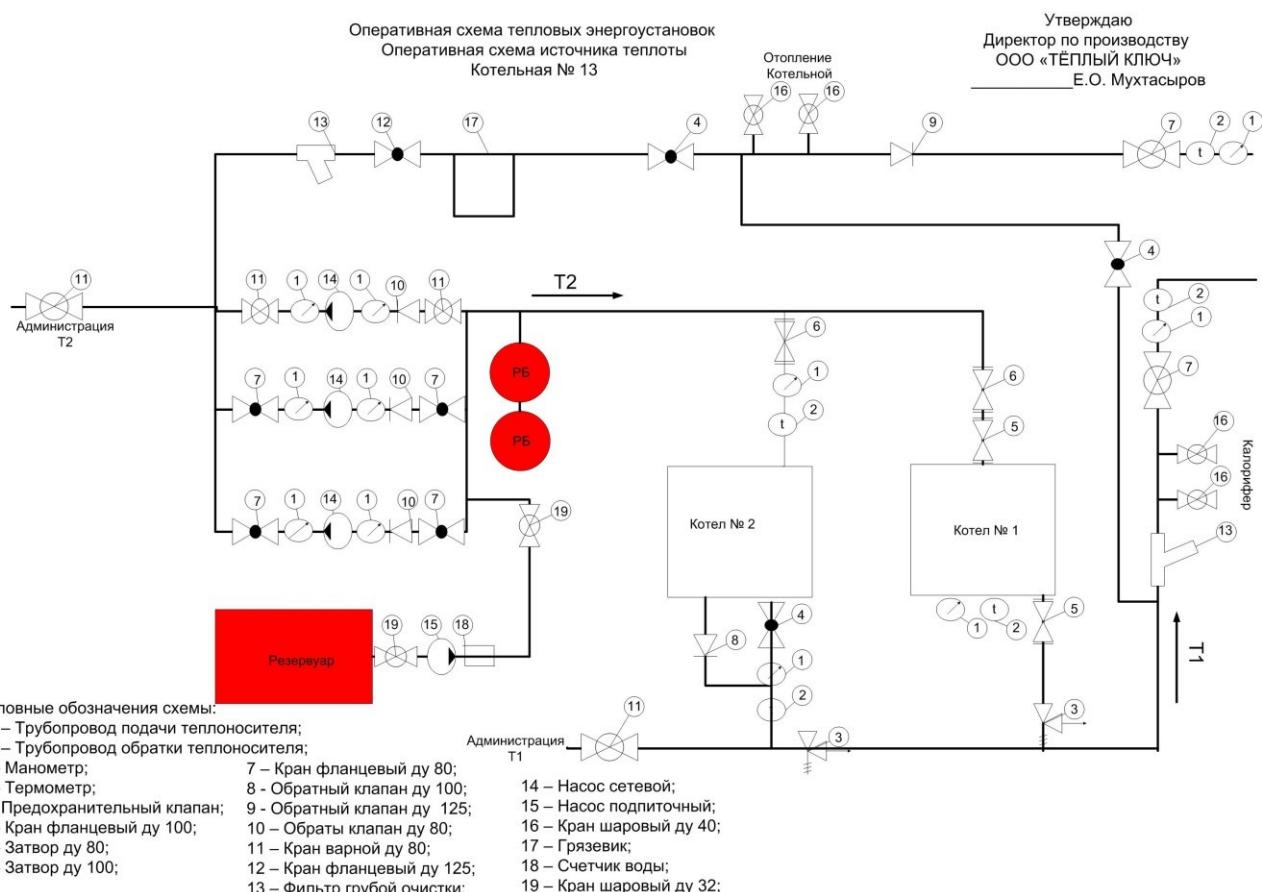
Принципиальная тепловая схема водогрейной котельной
